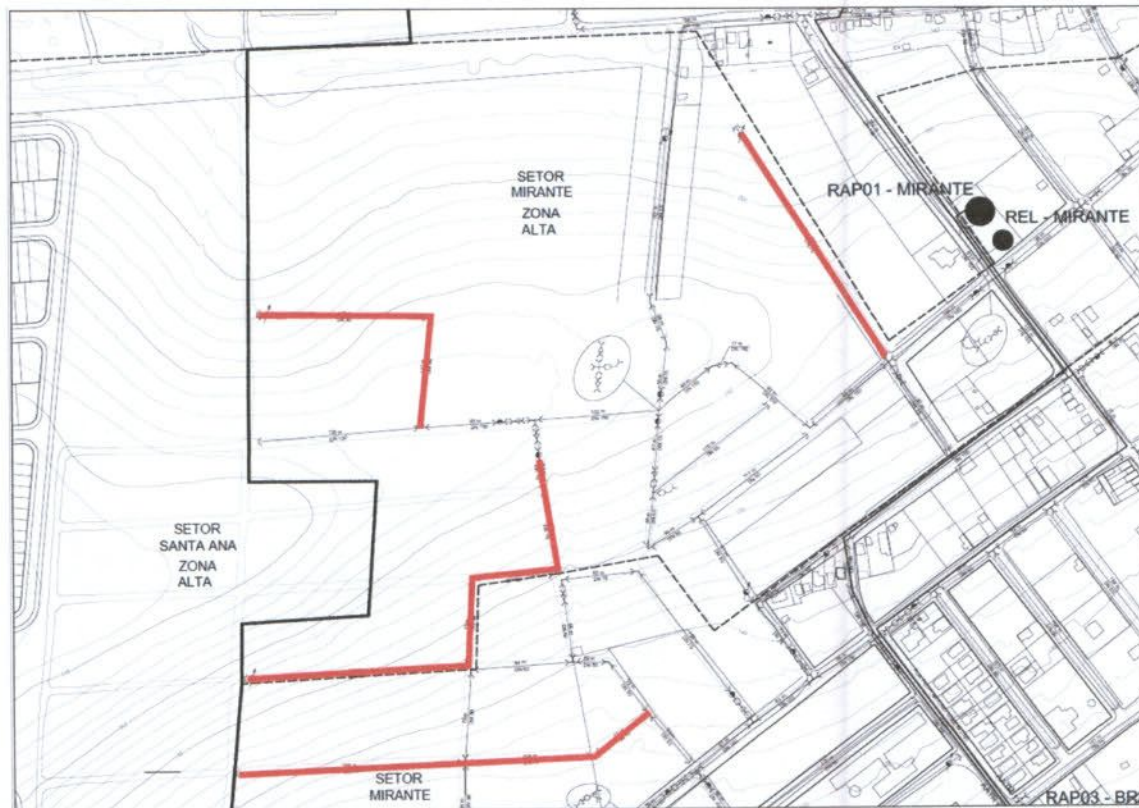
Setor Mirante - Zona Baixa – As linhas em vermelho são as tubulações não executadas
